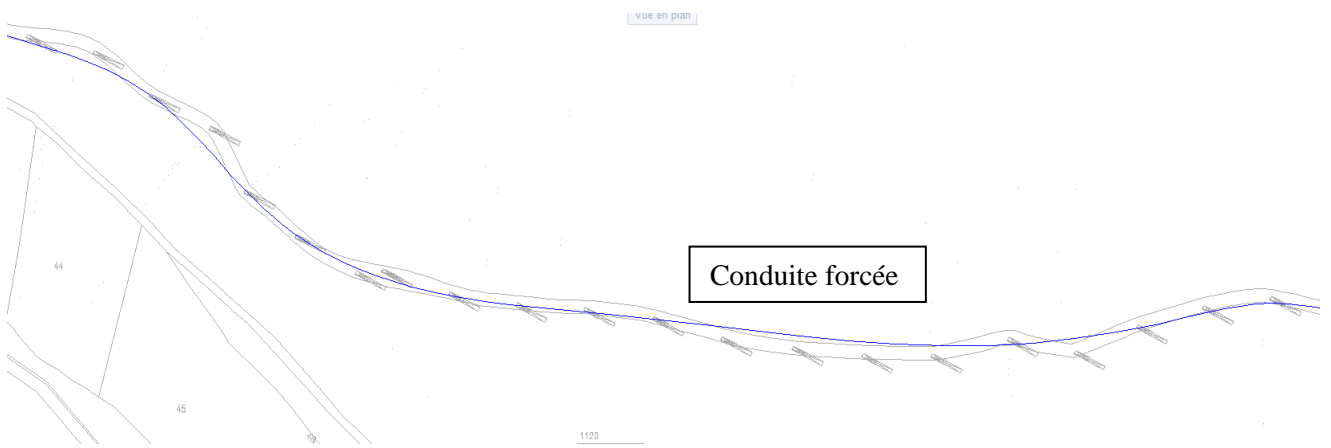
Implantation conduite forcée sur fond cadastral (2)
